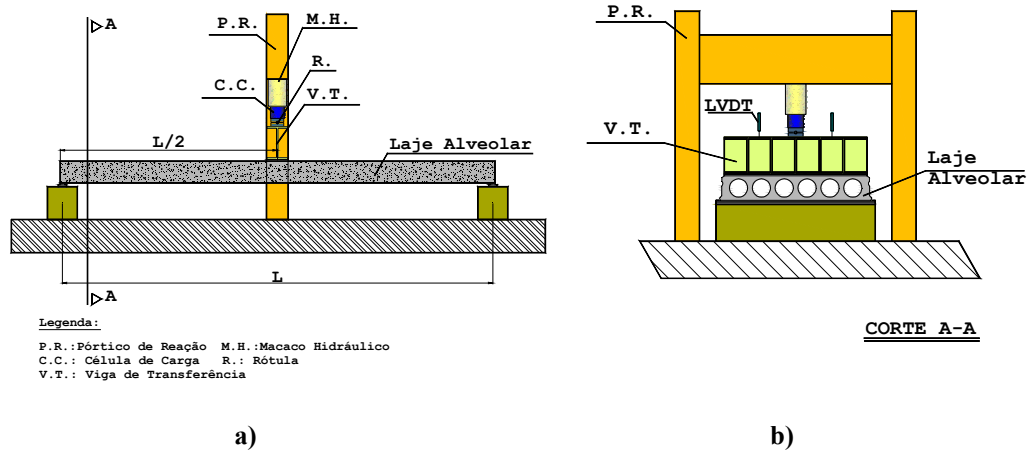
Desenho representativo do setup de ensaio de flexão:a) Vista lateral b) Vista frontal.
